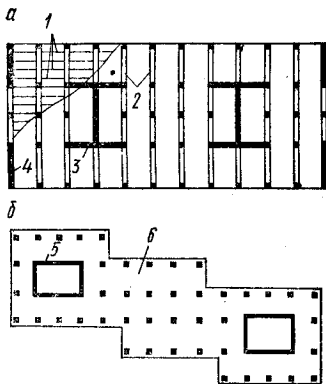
Конструктивные планы многоэтажных каркасных зданий
